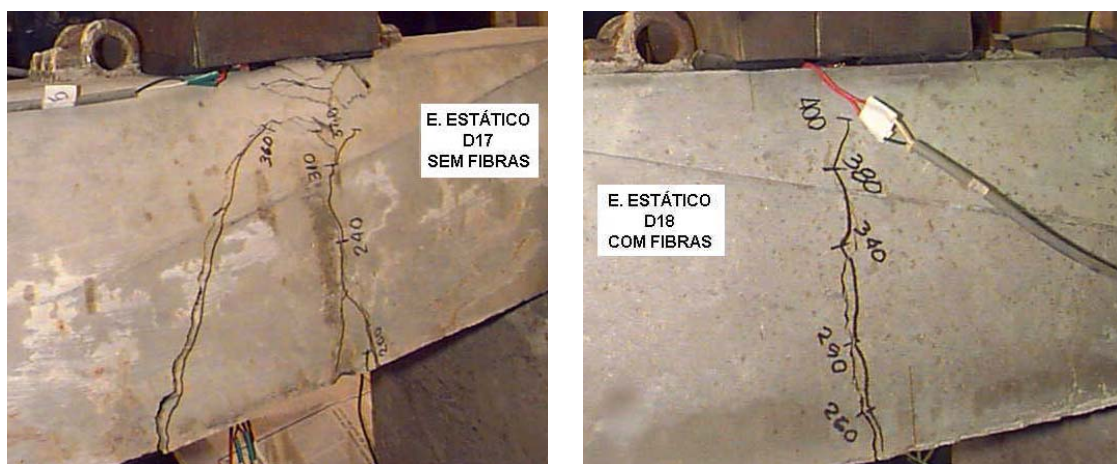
Configuração das fissuras na ruptura, dormentes modificados D17 e D18.
